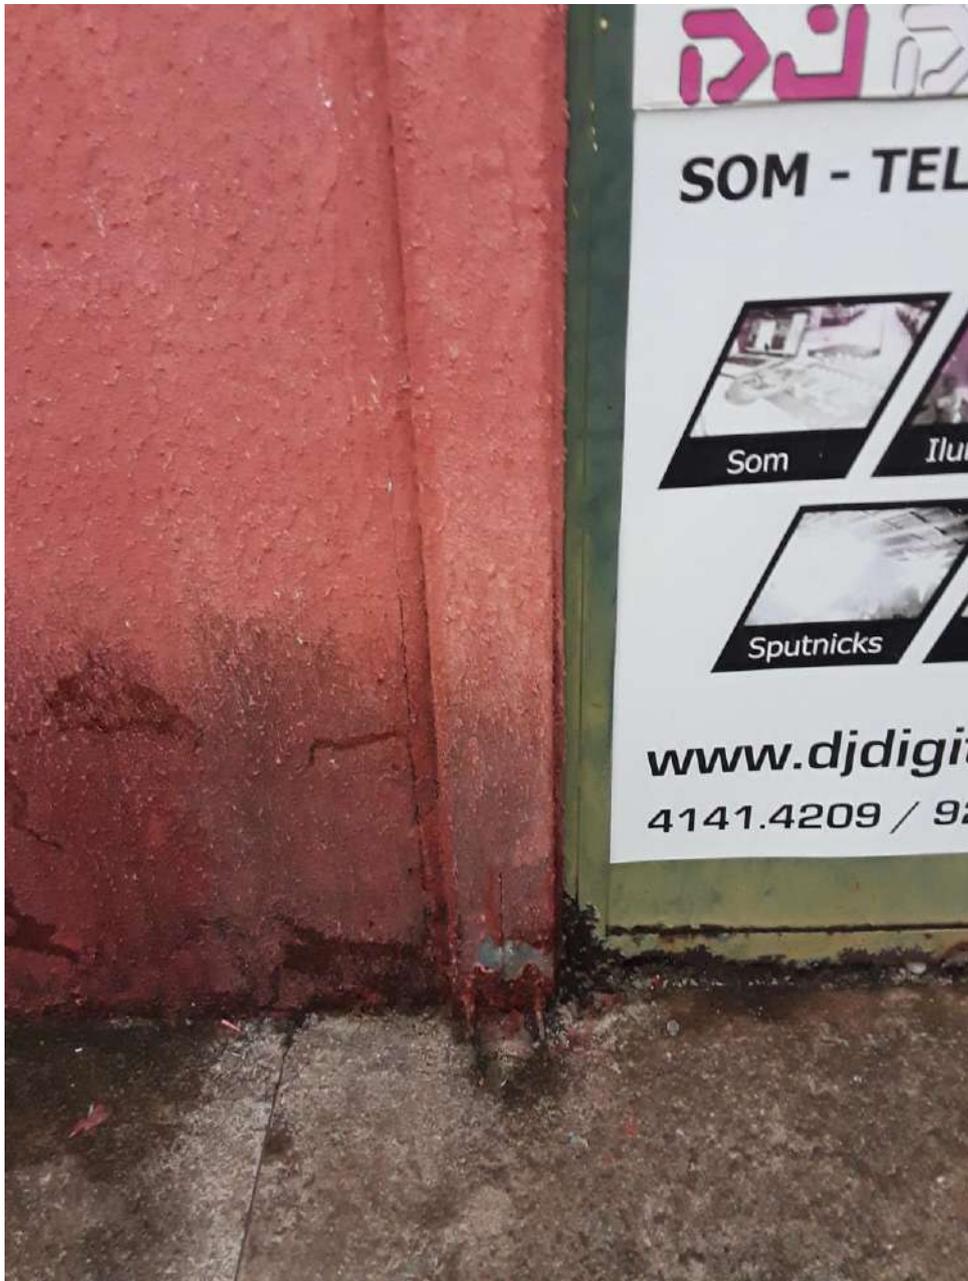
Base do Pilar 11 corrosão grau B
